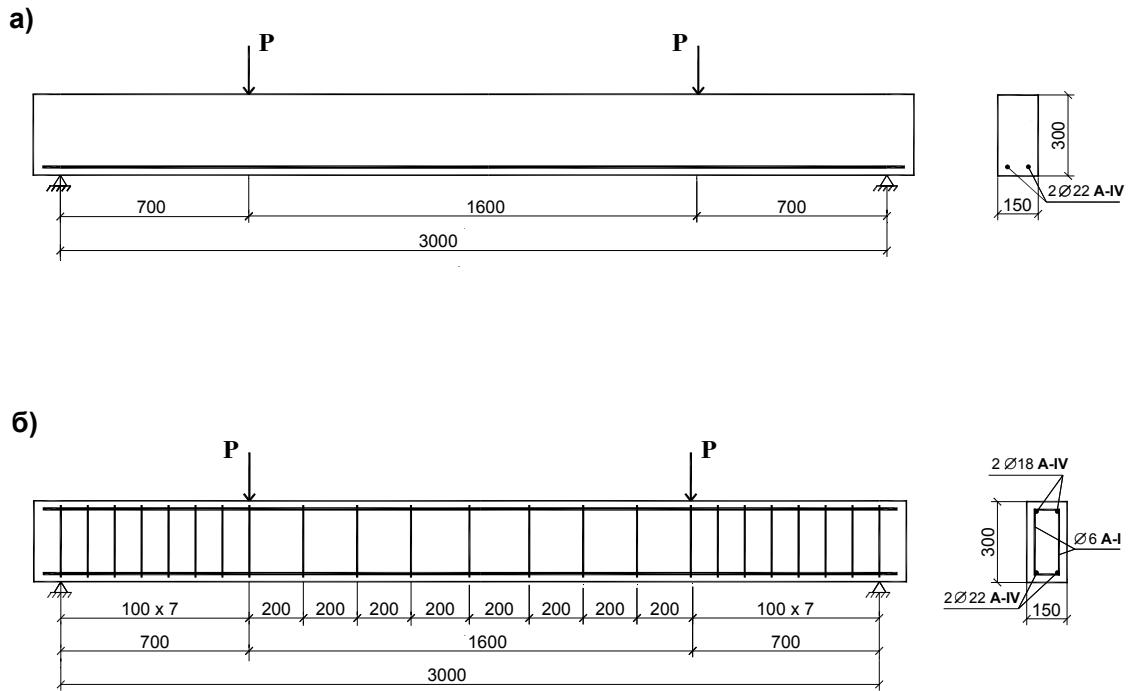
Конструкция железобетонных балок прямоугольного сечения:
